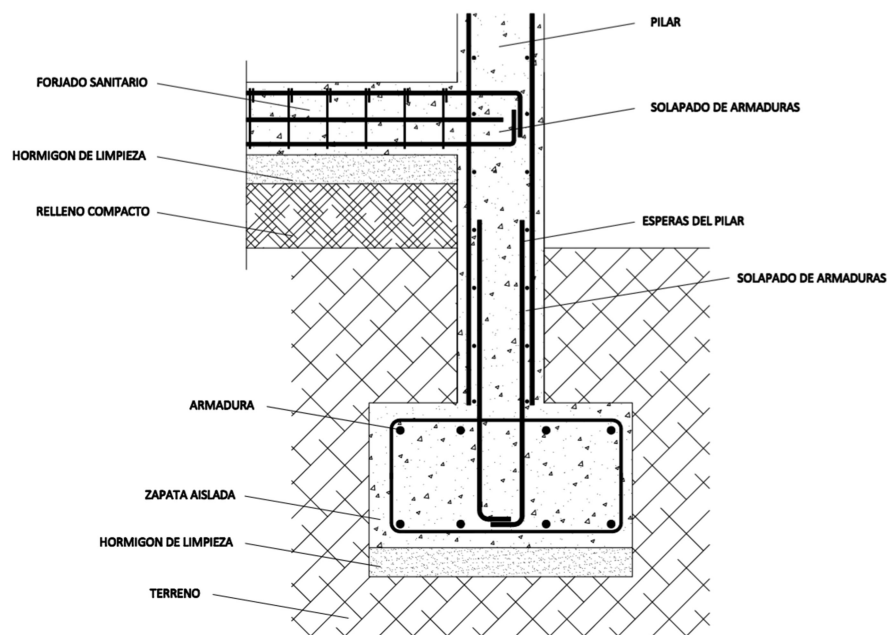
Sección de zapata aislada Fuente: Elaboración propia
